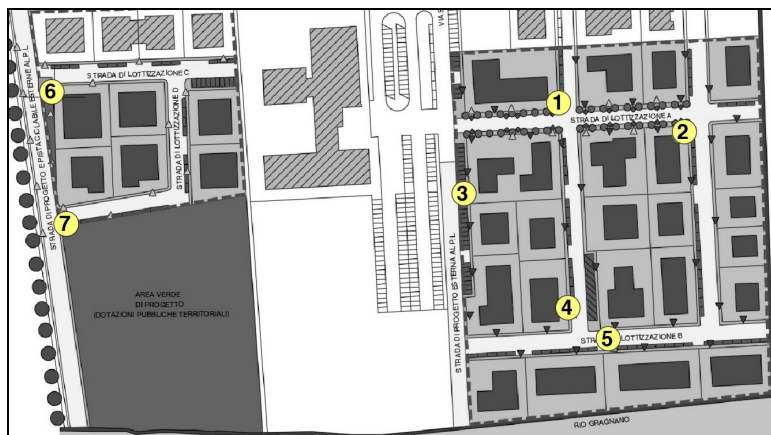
Posizione della piazzola ecologica rispetto al piano di lottizzazione in esame
